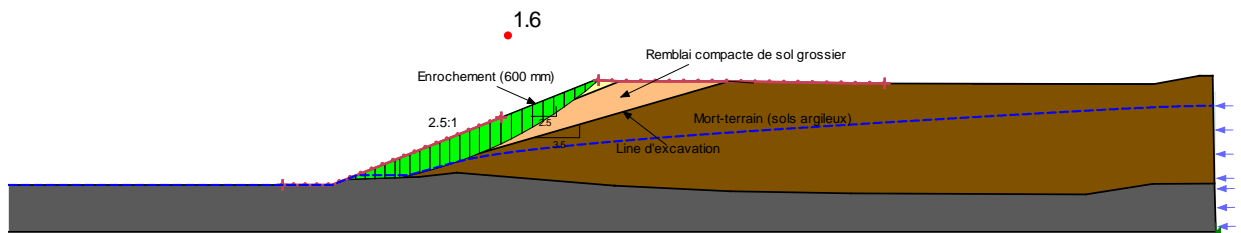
Stabilité long terme avec une couche d’enrochement de 600 mm, pente d’excavation 3,5H:1V et pente après le remblayage 2,5H:1V, excavation dans des sols argileux
